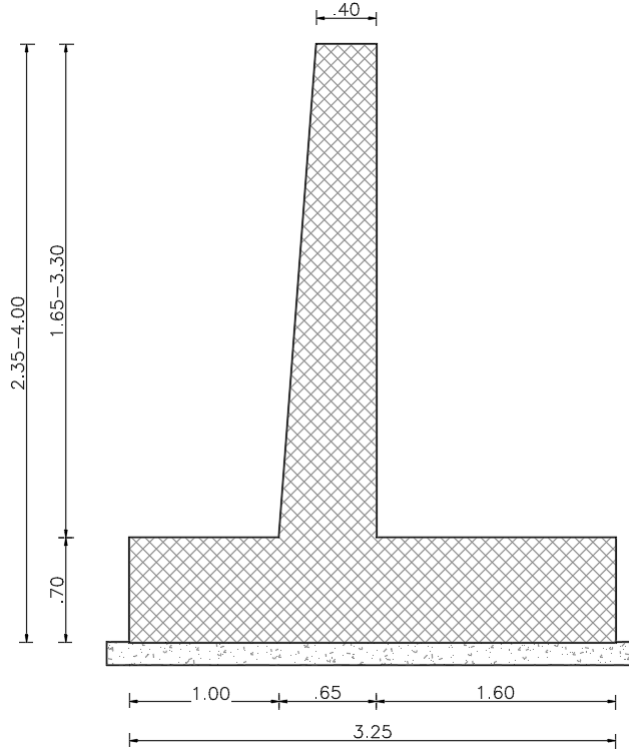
Sezione trasversale Muro Tipo 1 – Viabilità NV02B
